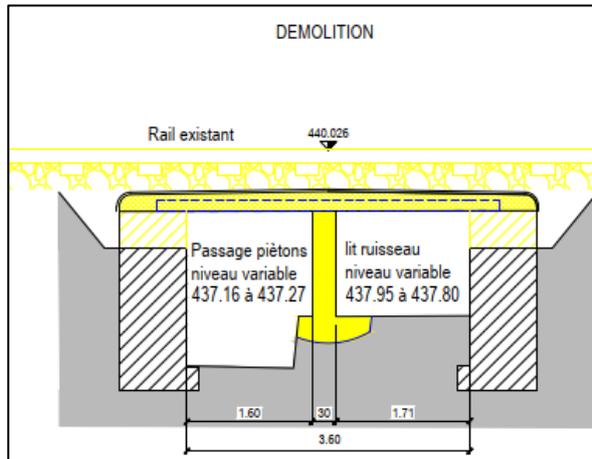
Coupe aqueduc démolì - Extrait plan PGSA
